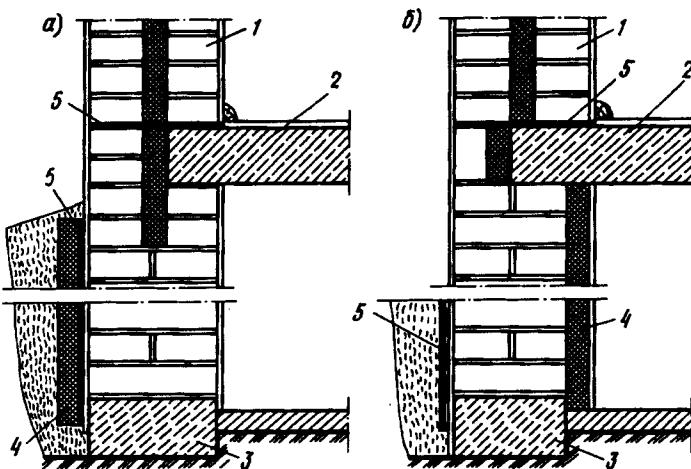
Утепление стен подвалов пенопластом с наружной (а) и внутренней стороны (б)
